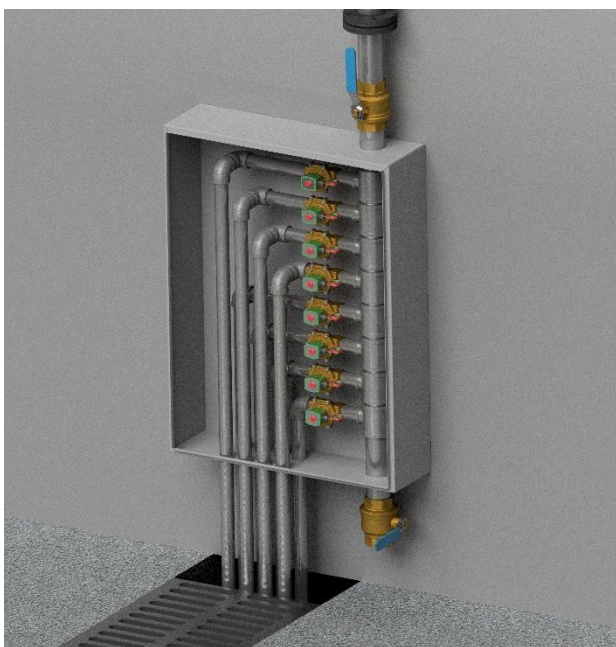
Gabinete de válvulas mural para 8 zonas de ILDFA
